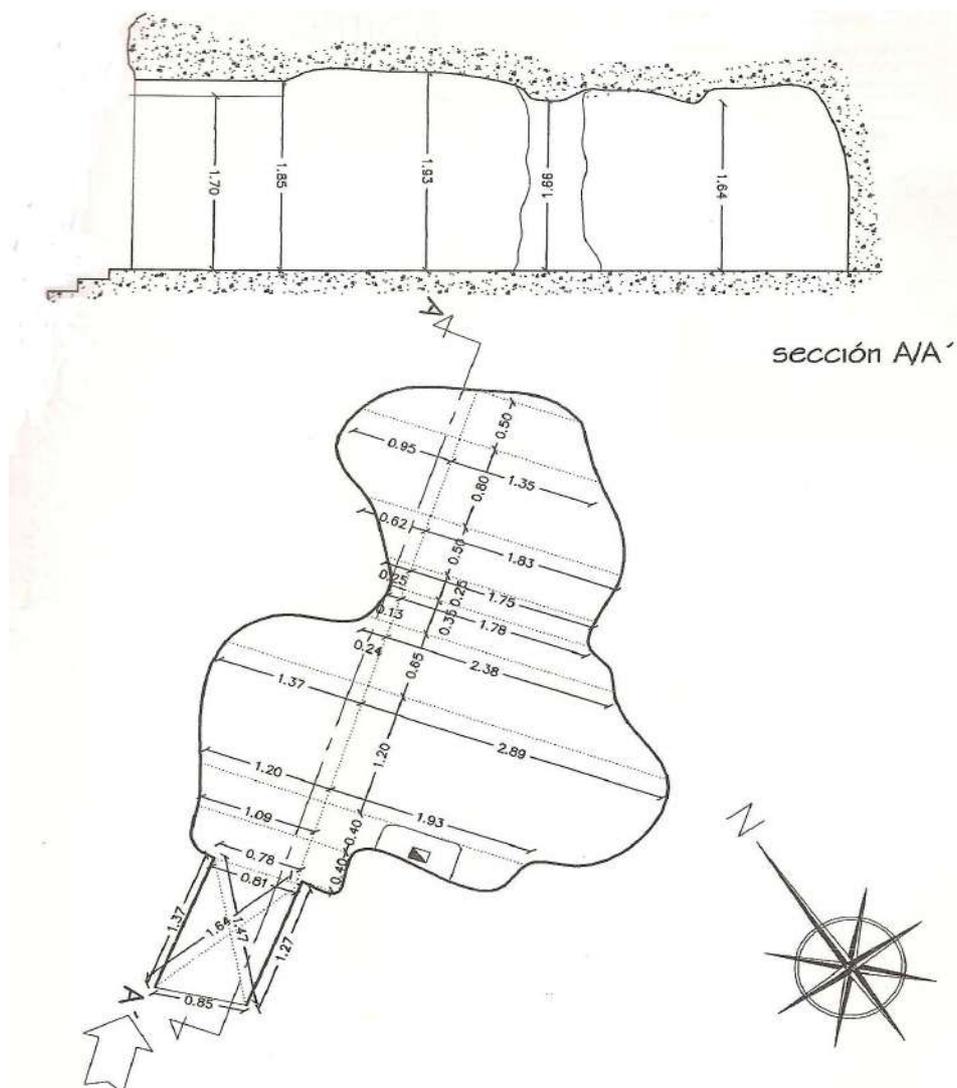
Cueva Cestería. Planta acotada y sección, escala 1/50
